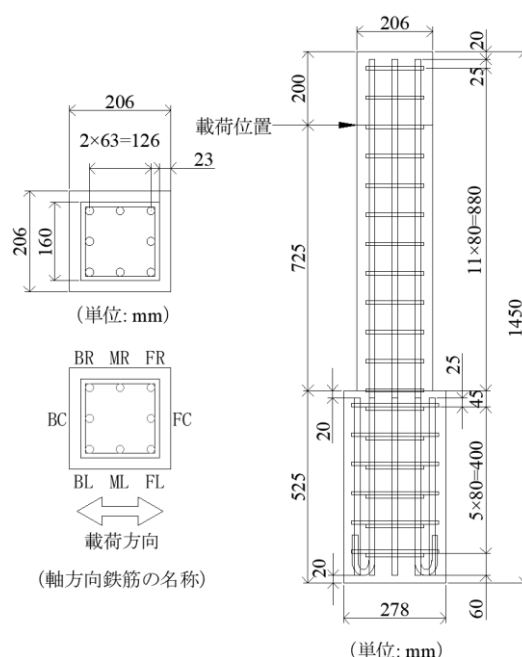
供試体の側面図，断面図および軸方向鉄筋の名称
